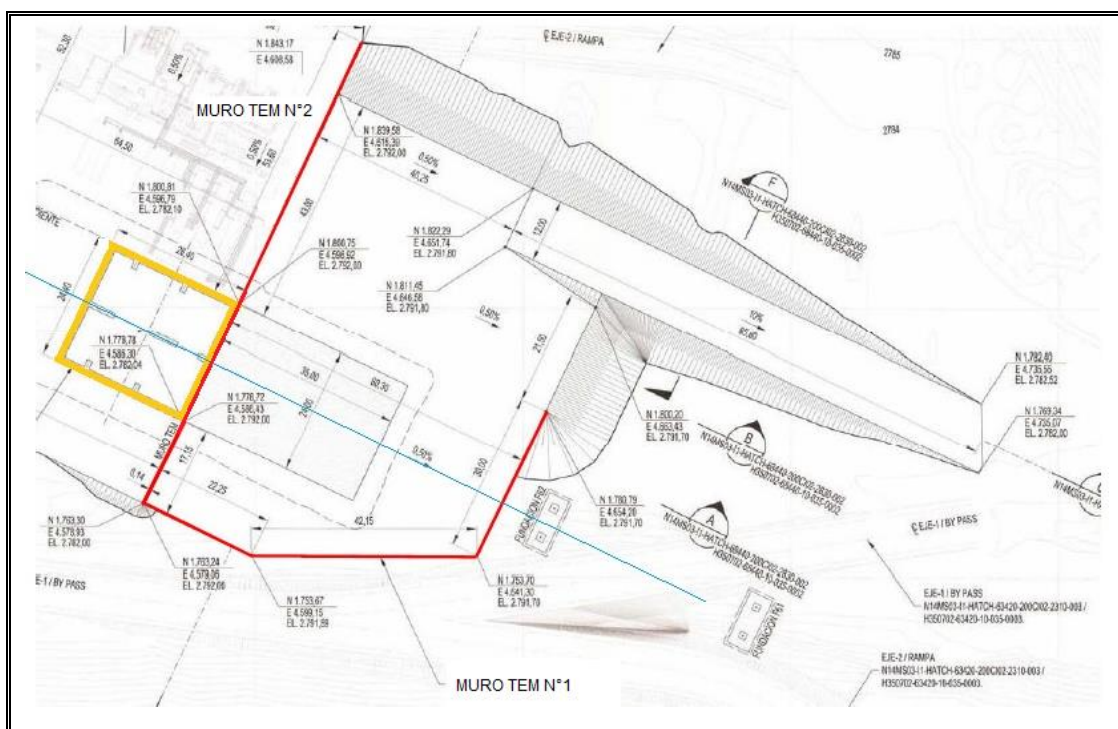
Vista en planta del muro TEM. Adaptada de (CMGI, 2019)
